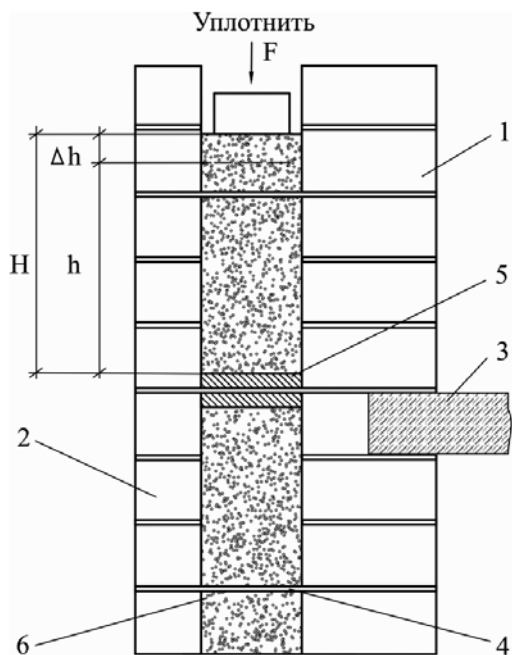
Трехслойная стена с элементами конструкции и схема уплотнения ПВС: 1 – несущий слой; 2 – облицовочный слой; 3 – перекрытие; 4 – гибкие связи (арматура); 5 – противопожарная рассечка; 6 – ПВС
